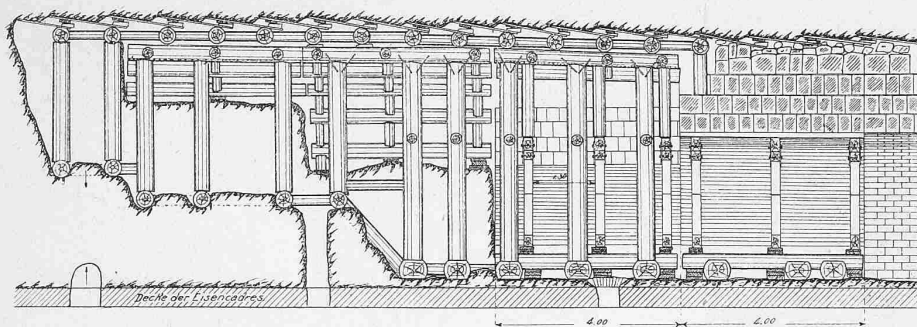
Längsschnitt durch Gewölbe-Rüstung und Mauerung — Masstab 1 : 150.
